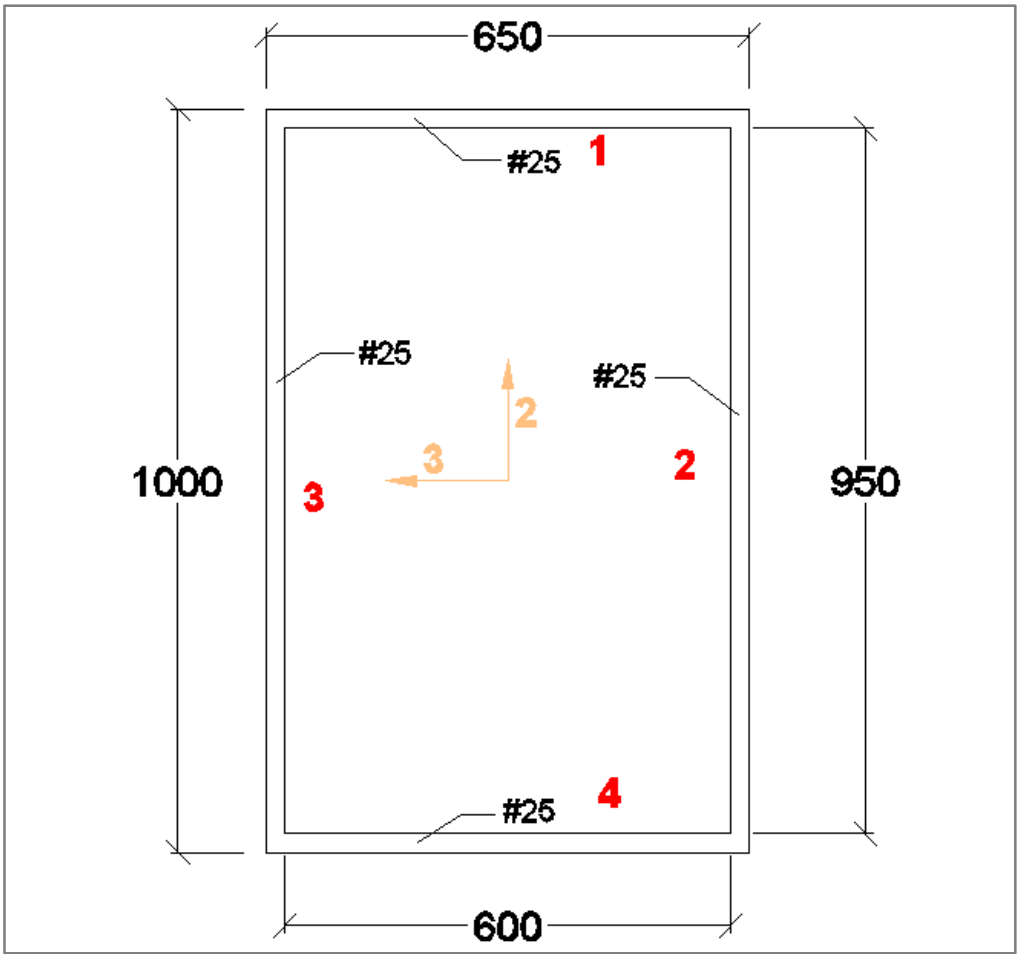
Dimensiones cajón arranque de arcos (Cotas en mm)
